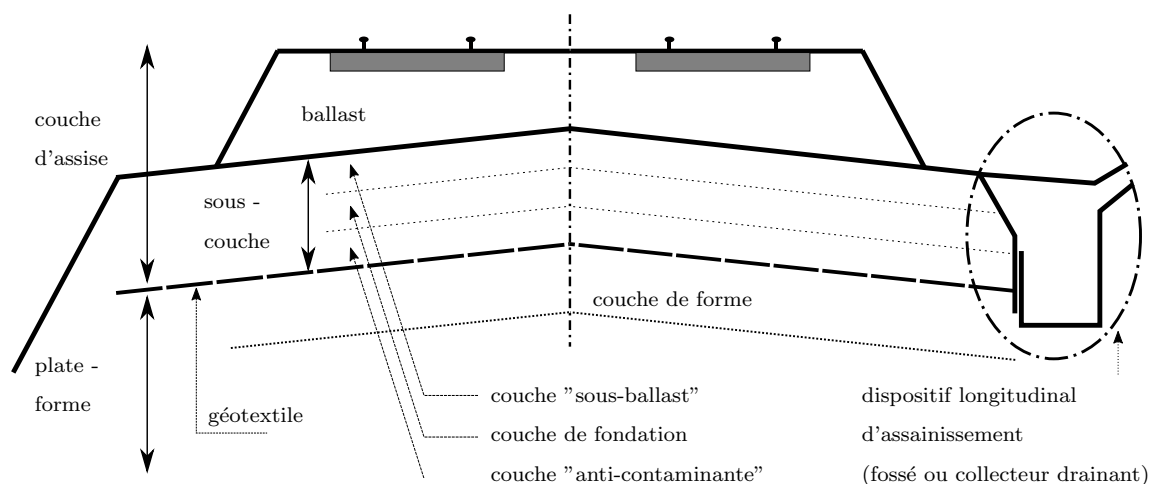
Profil en travers schématique d'une voie ballastée
